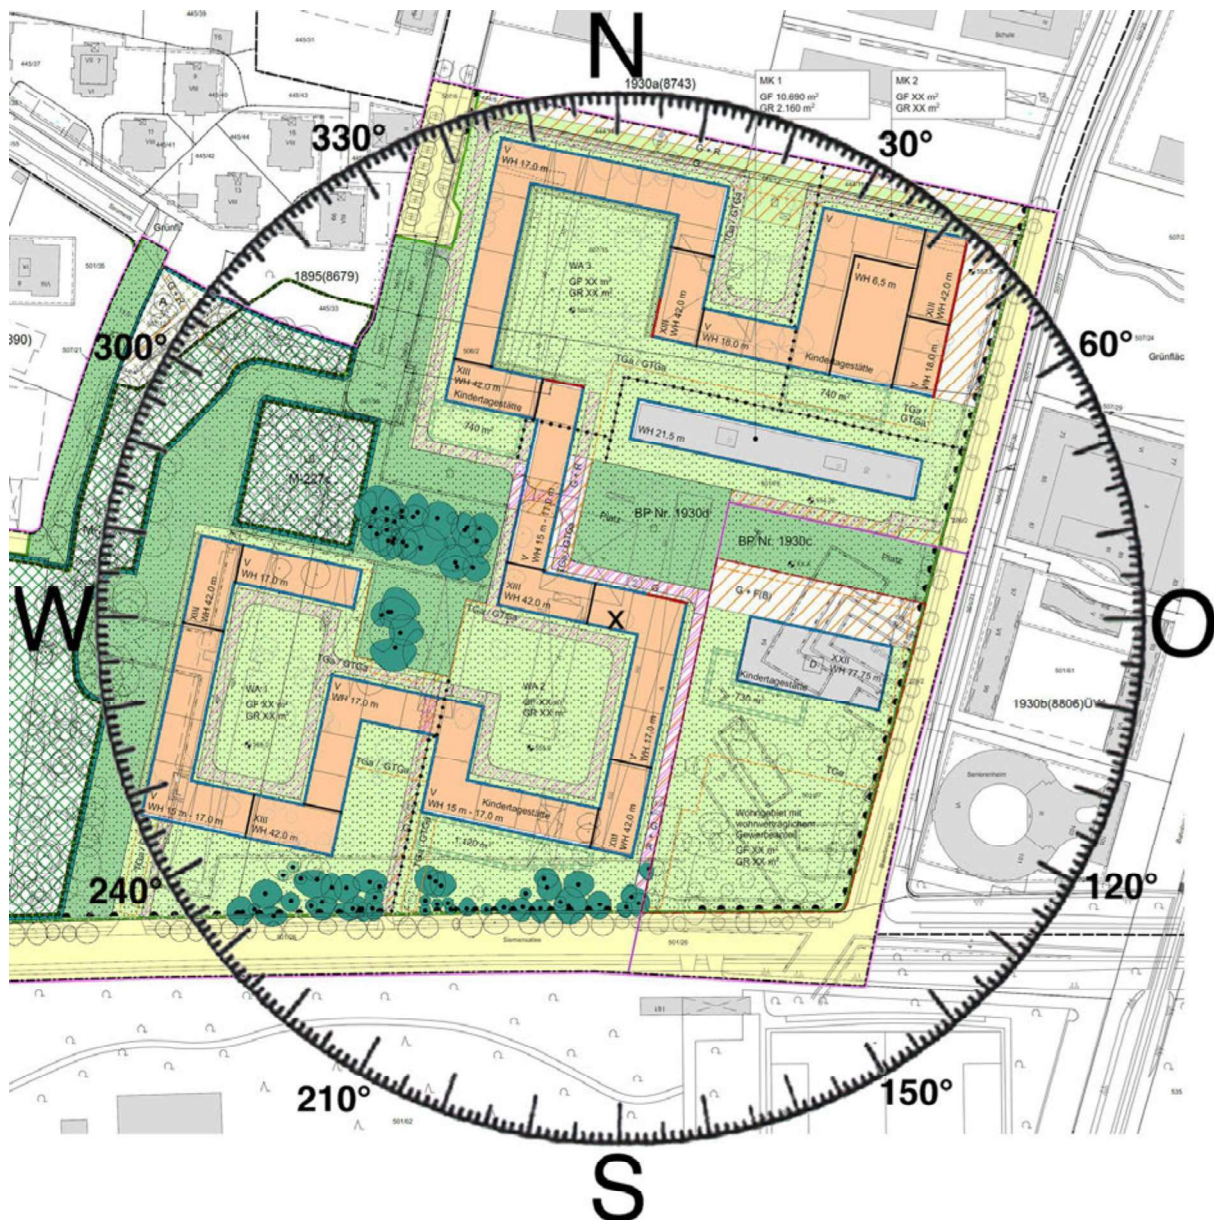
Lageplan der Hofmann Höfe mit Windrichtungsskala
